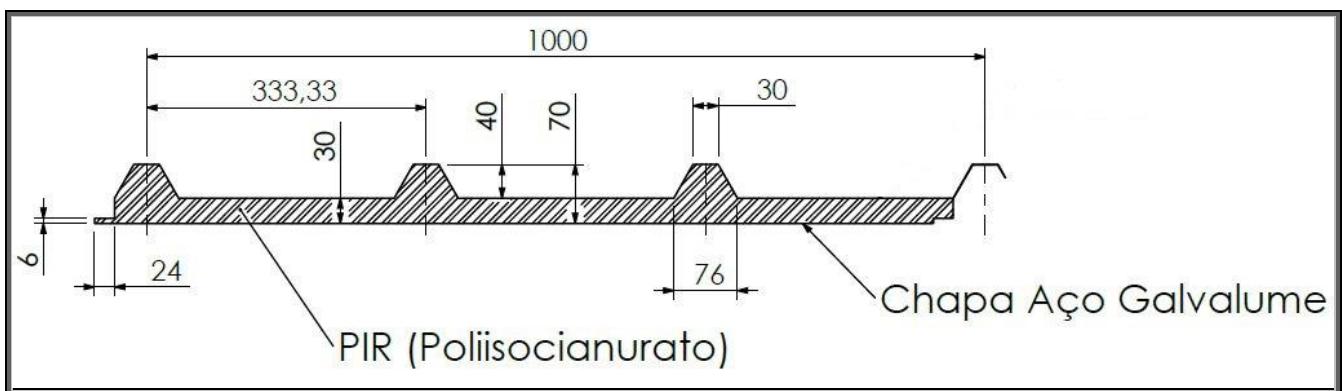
Seção transversal do painel de telhado (Dimensões em mm).
